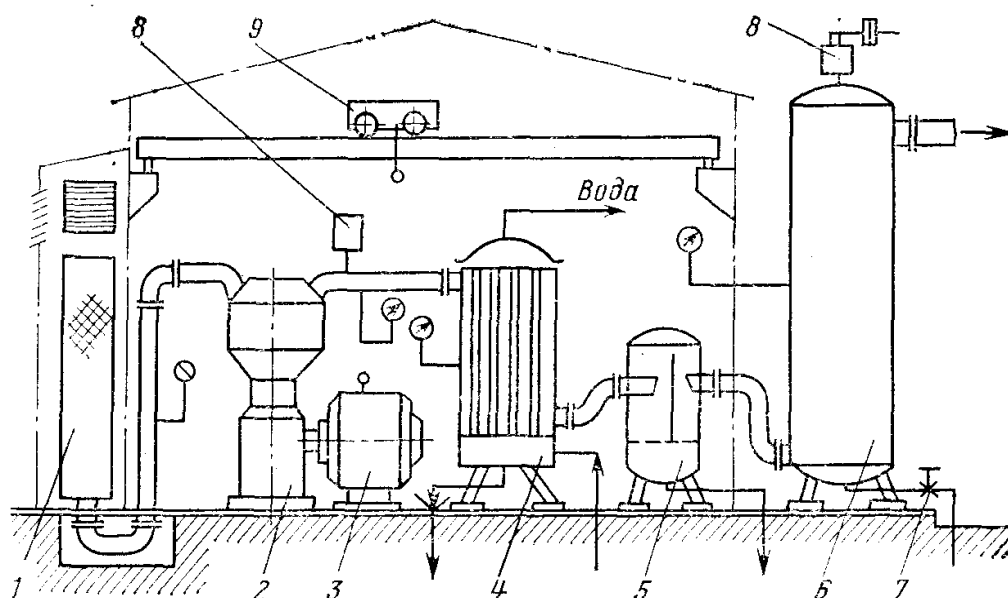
Схема компрессорной установки с поршневыми компрессорами:
